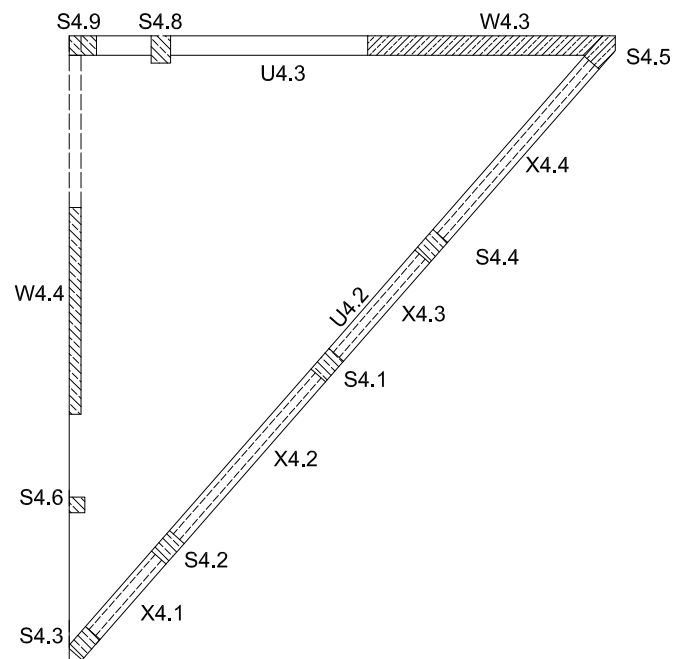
Bürohaus X: Grundriss Dachgeschoss [Lie09]
